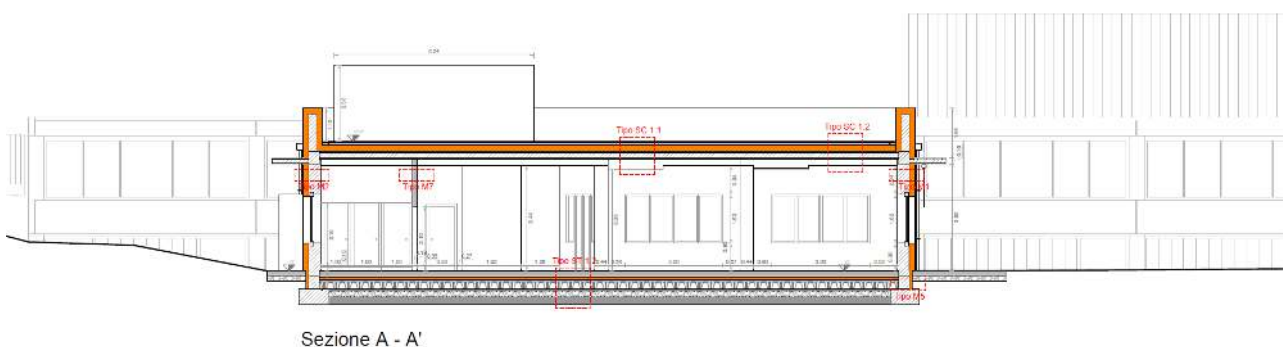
Sezione AA. Estratto Tav.04.2 Stato di progetto_Sezione e dettagli
